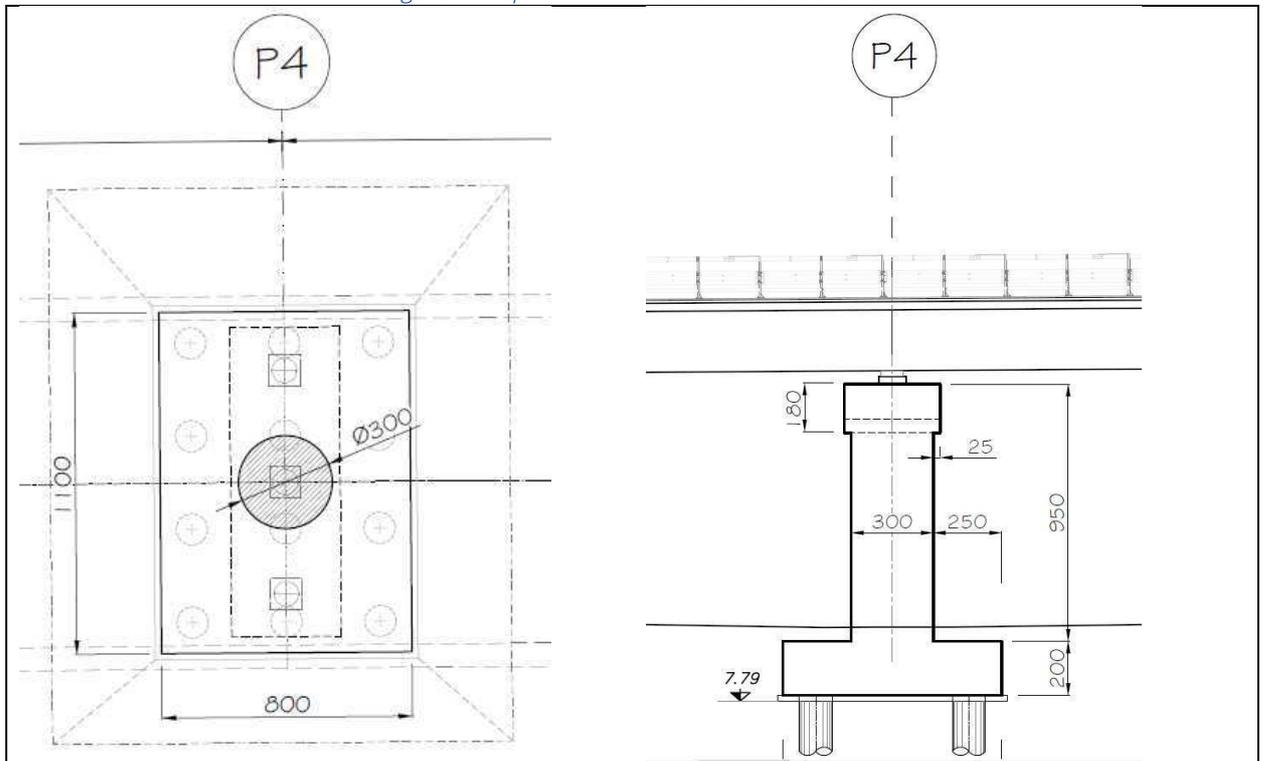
Pila4 - Pianta Fondazioni e Sezione
